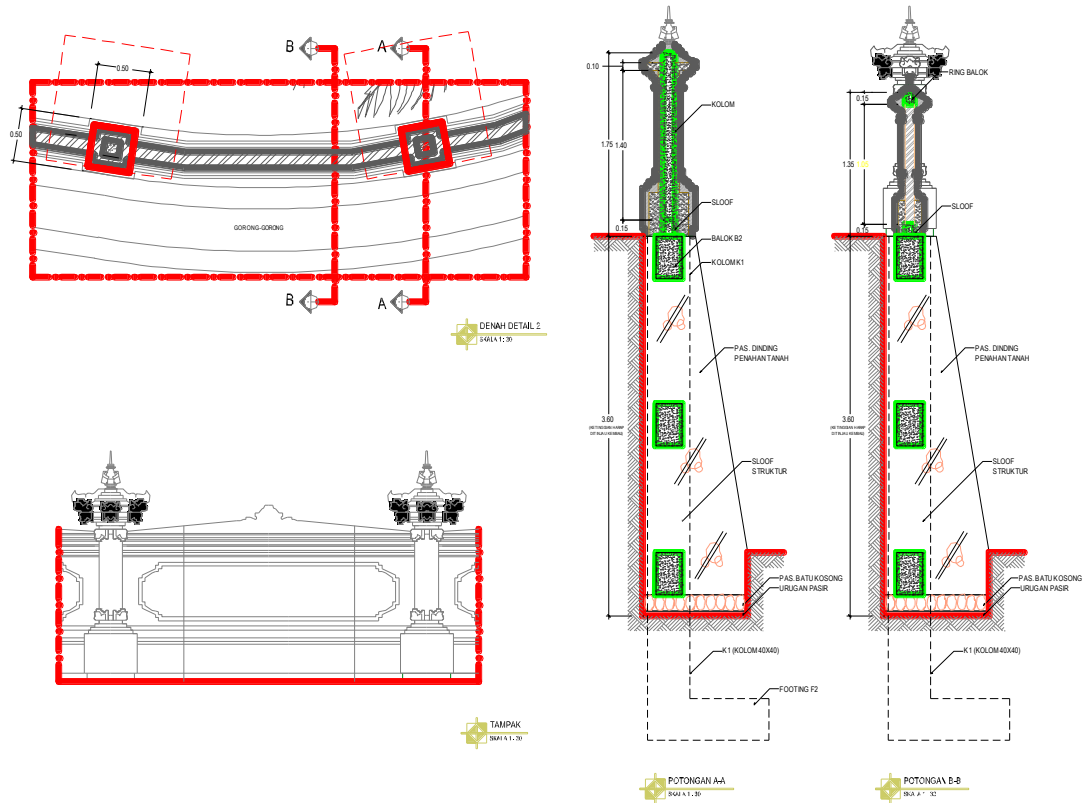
Denah Rencana Pemasangan Dinding Pagar Pura Kereban Langit
